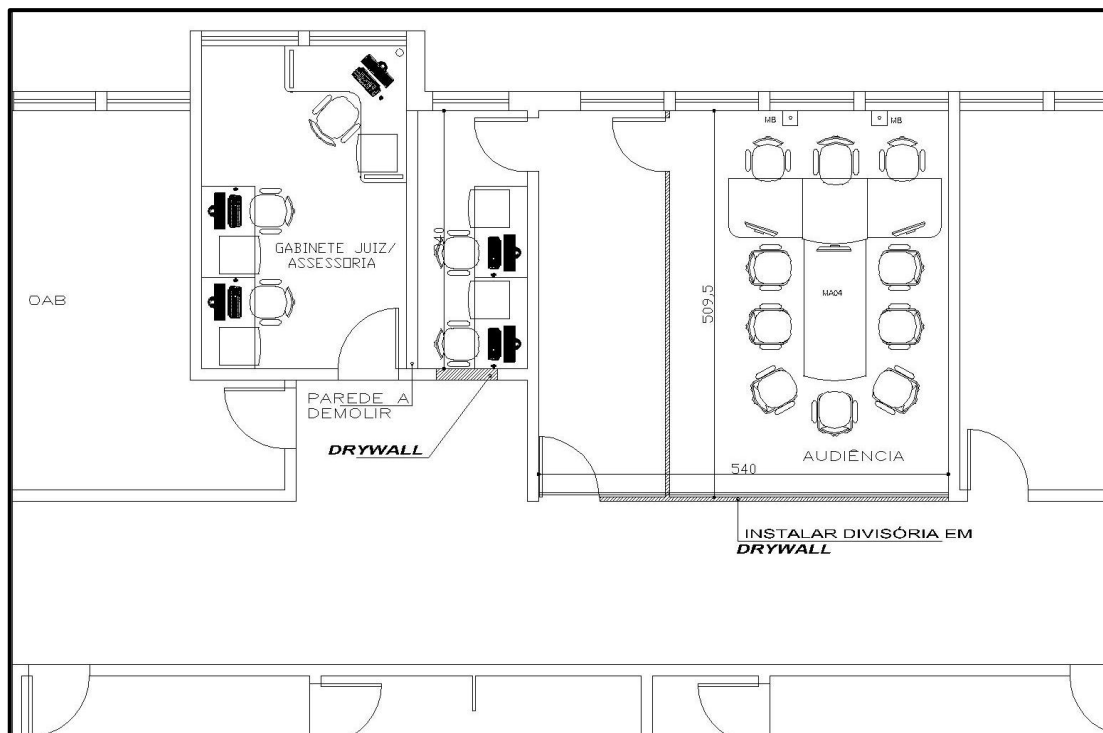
As *hachuras* representam as paredes construídas em *drywall*.
